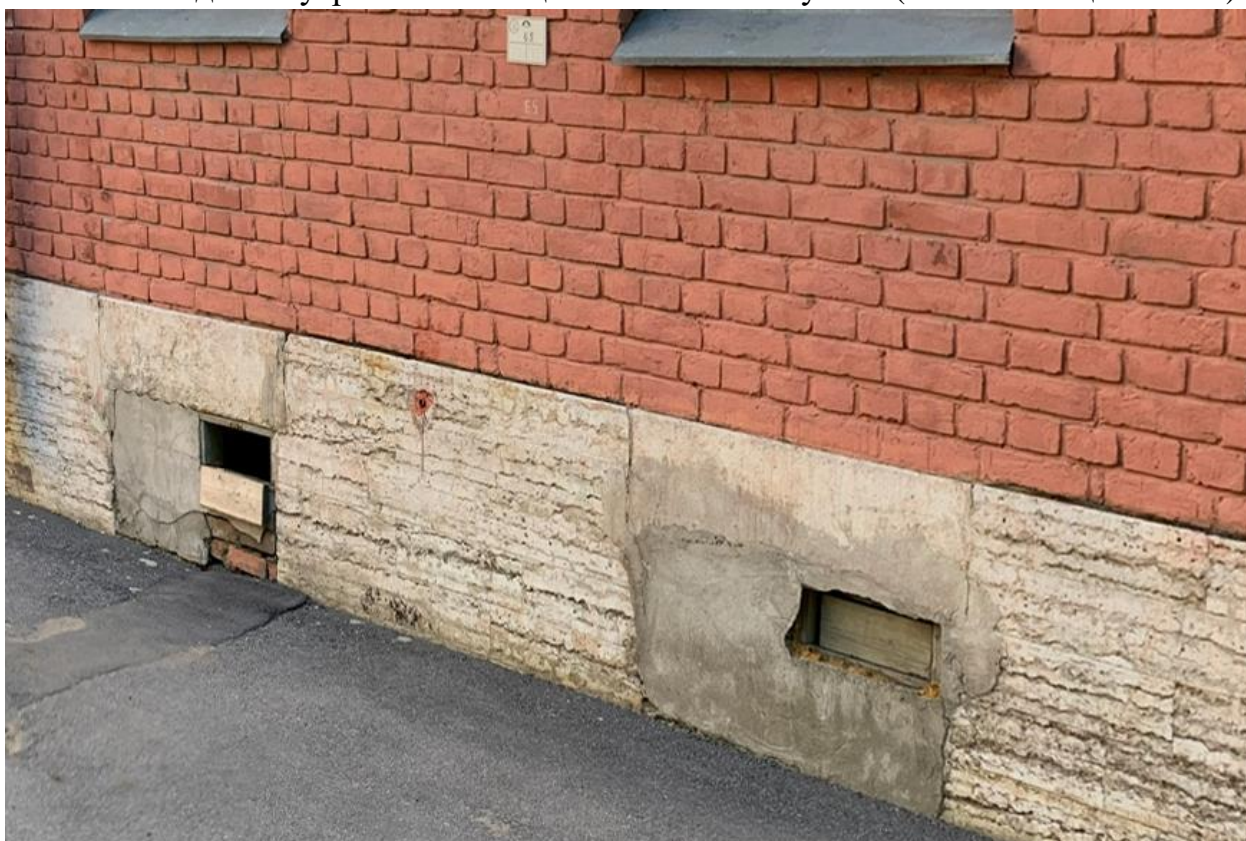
Вид на оконные проемы цоколя (ввод тепловой сети в помещение 3-Н со стороны фасада).
